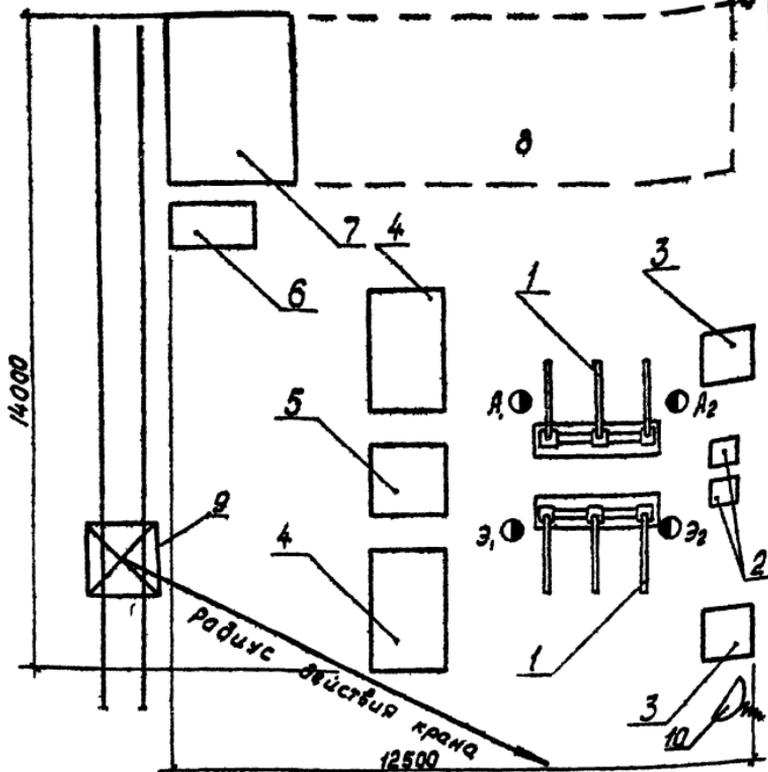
Схема организации поста сборки и сварки арматурных блоков поддонников.
